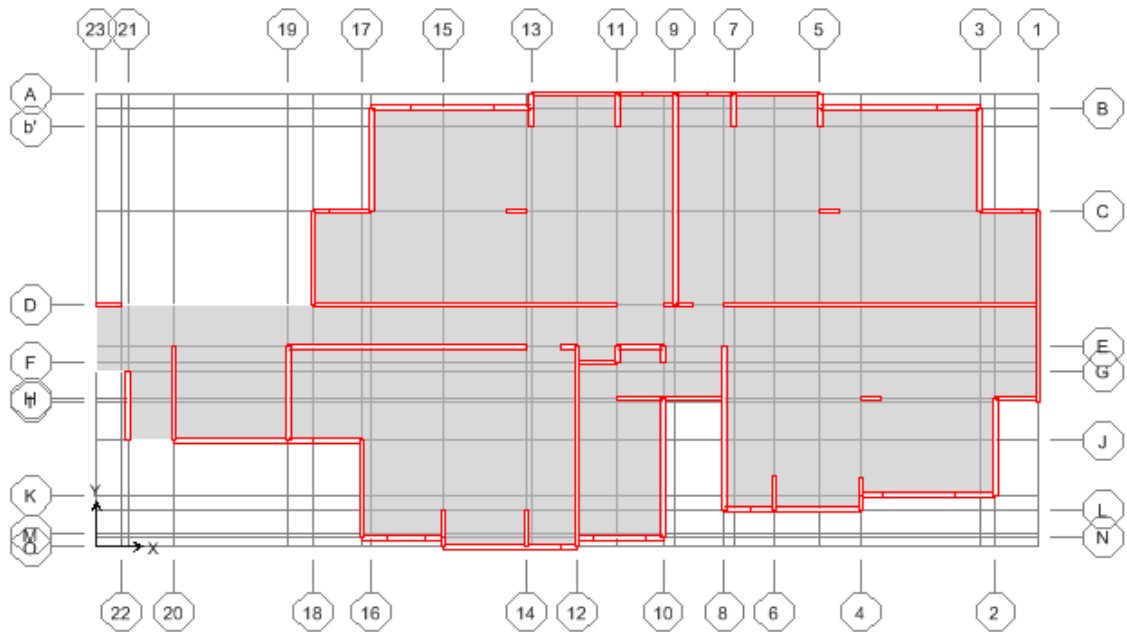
j Distribución en planta de vigas, columnas, placas y losas utilizado en el análisis para un piso típico
